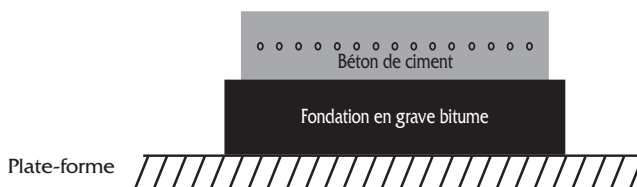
structure composite constituée d'un revêtement en béton armé continu posé sur une fondation en grave-bitume.
